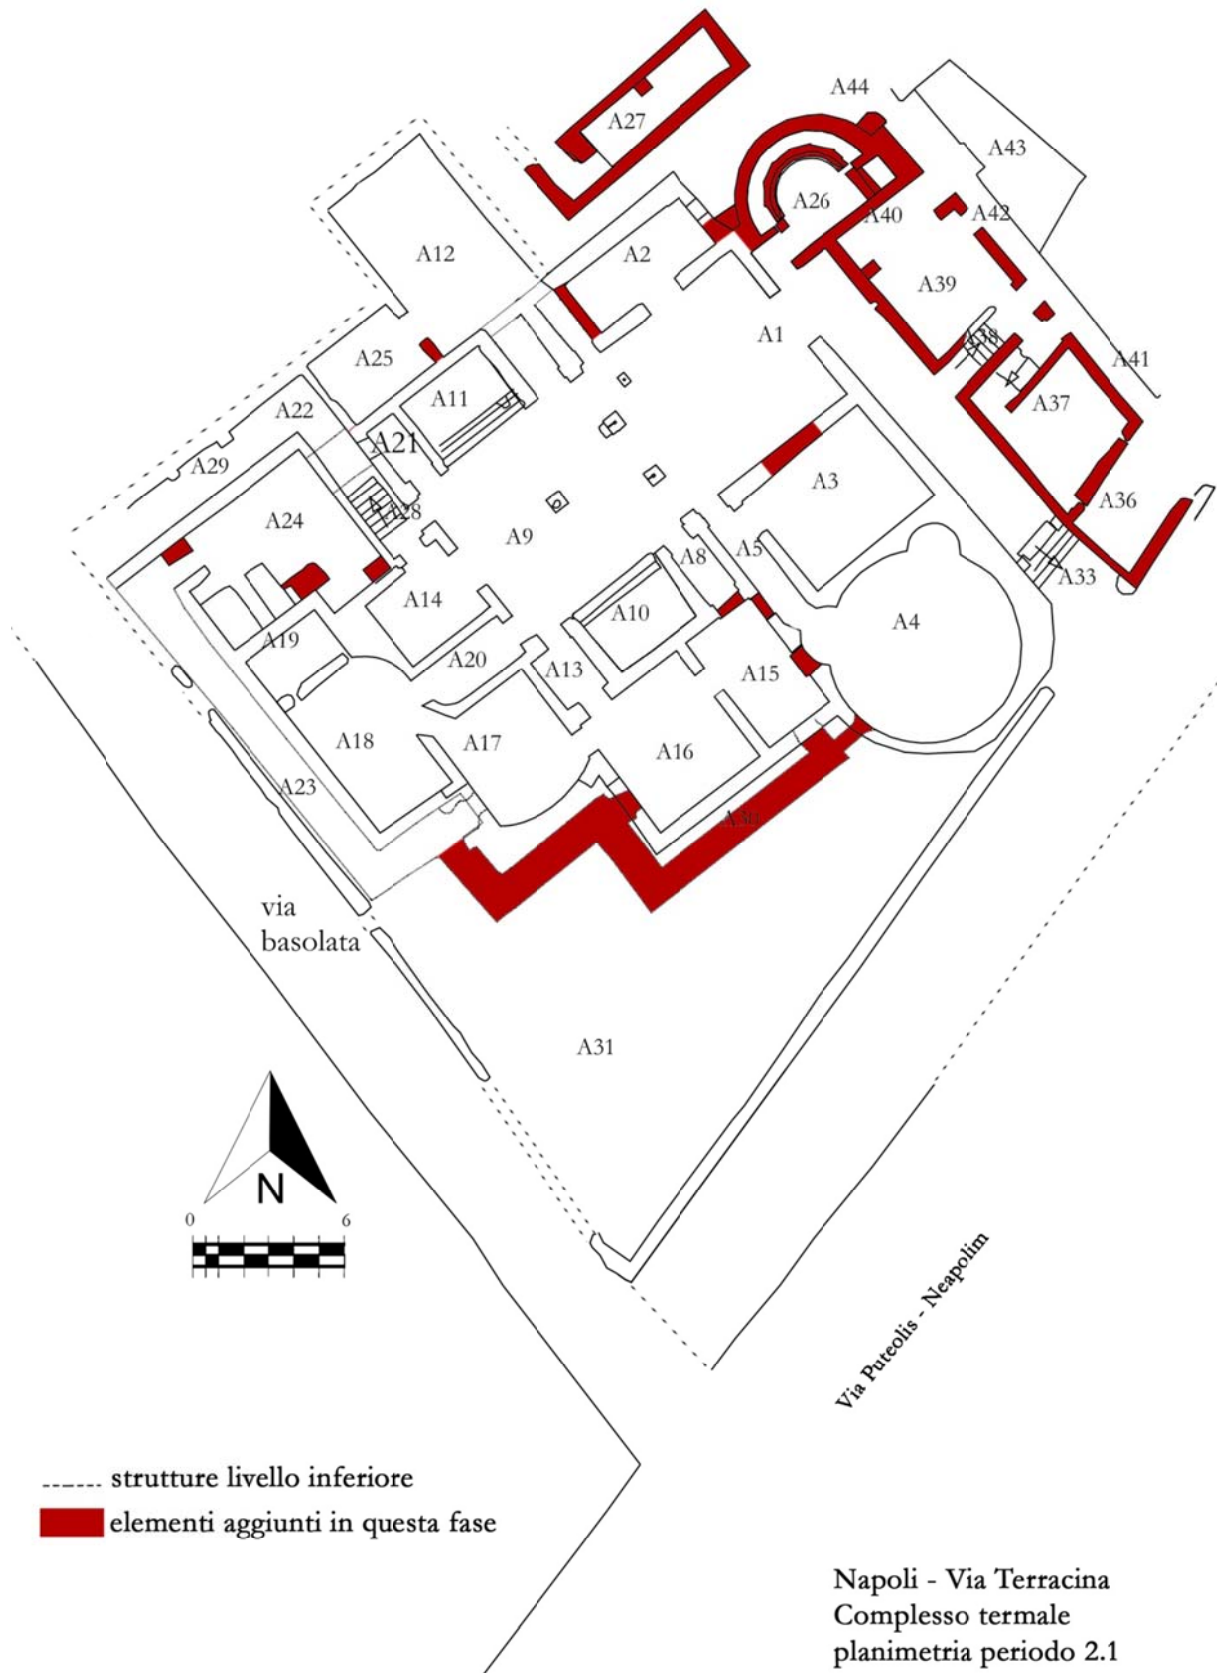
Planimetria dell'impianto del periodo 2.1
